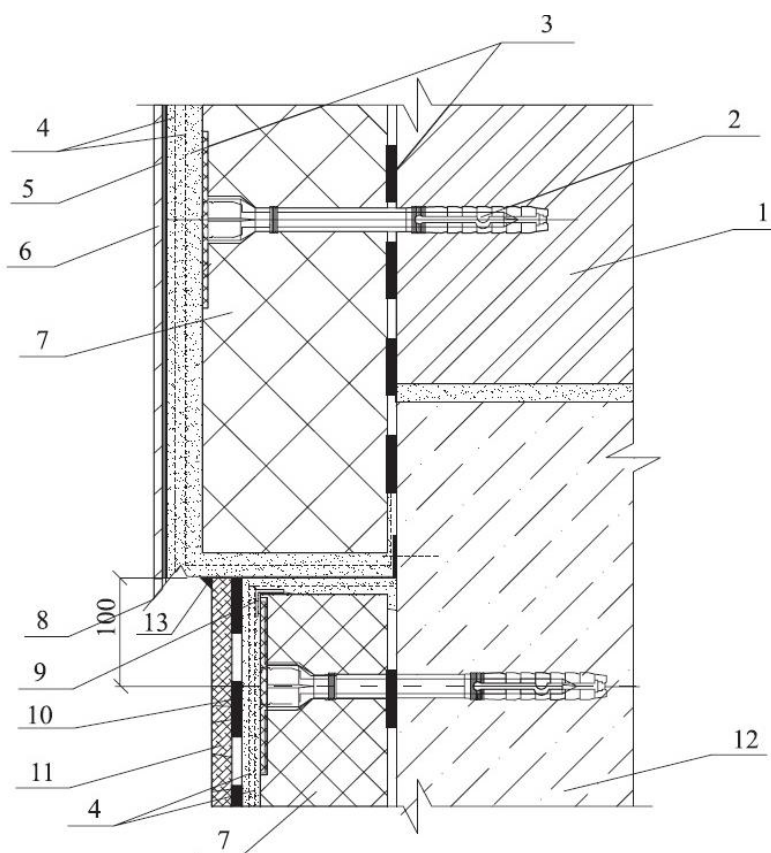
Утеплення цокольної частини будівлі. Примикання до системи теплоізоляції на фасаді
